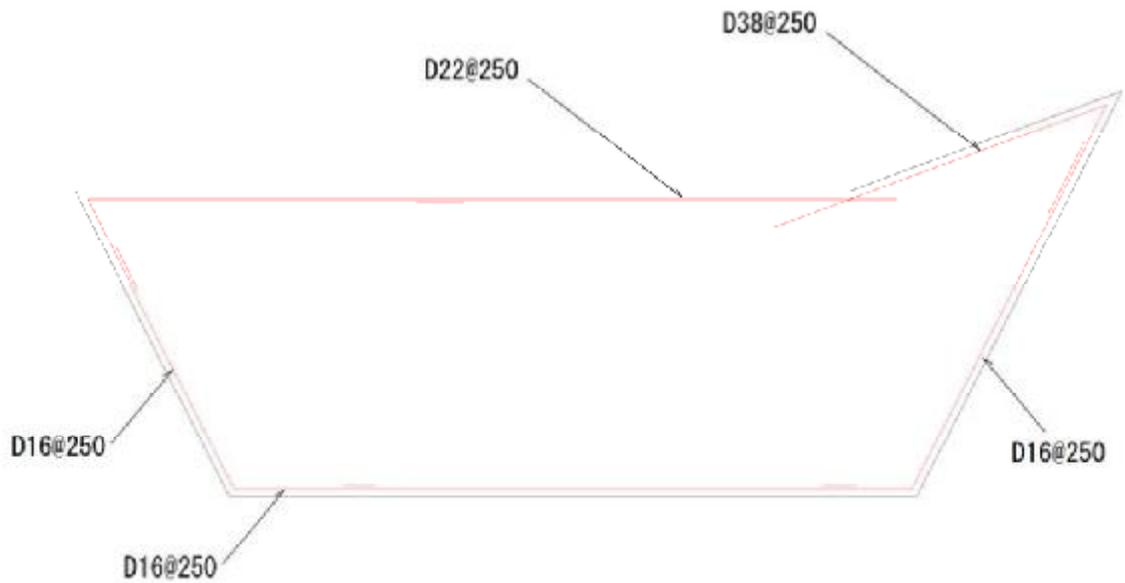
コア敷き置換コンクリート配筋要領図
